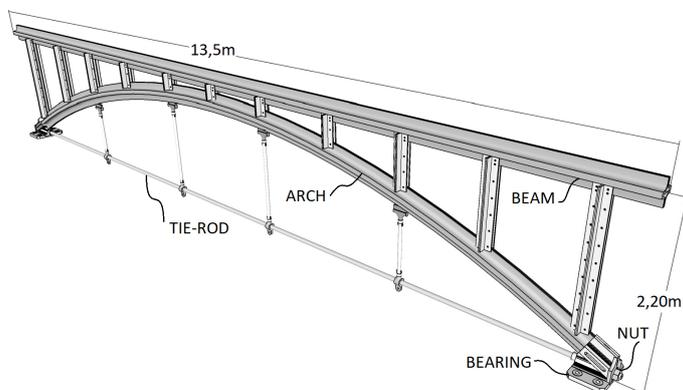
; DESENHO ORIGINAL - VISTA LONGITUDINAL [4]
